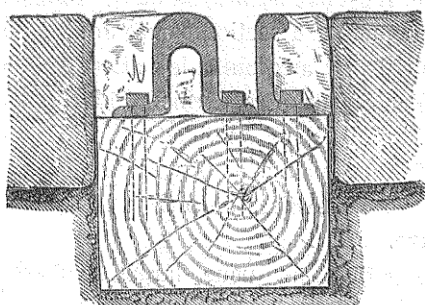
Tramway du port de Belfast, système Lizars. Échelle 1/8.
